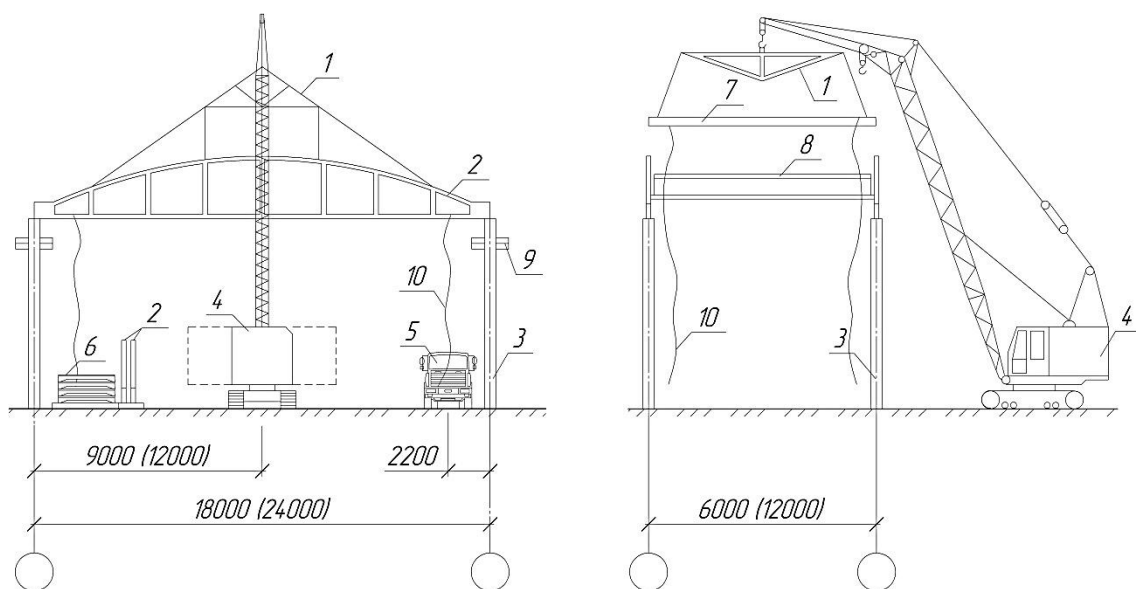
Схема монтажа ферм пролетом 18, 24 м и плит покрытия продольным методом: 1 – траверса; 2 – стропильная ферма; 3 – колонна; 4 – кран; 5 – транспортное средство; 6 – штабель плит; 7 – монтируемая плита; 8 – временное ограждение; 9 – лестница-площадка приставная; 10 – оттяжка
